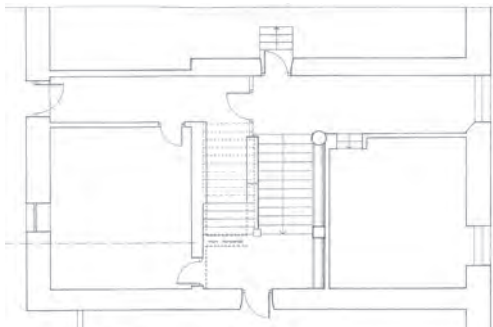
39. PLANTA BAJA. ESTADO ANTERIOR A REFORMA
